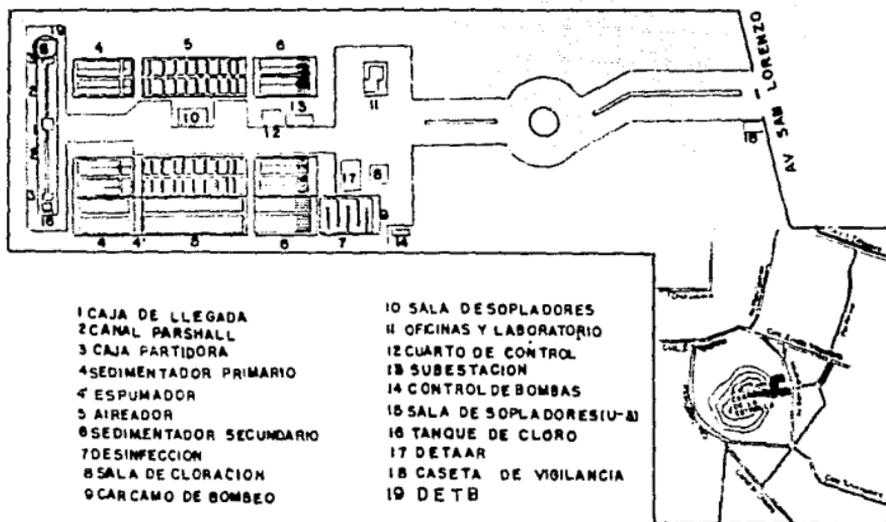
Estructura global de la planta Cerro de la Estrella.
